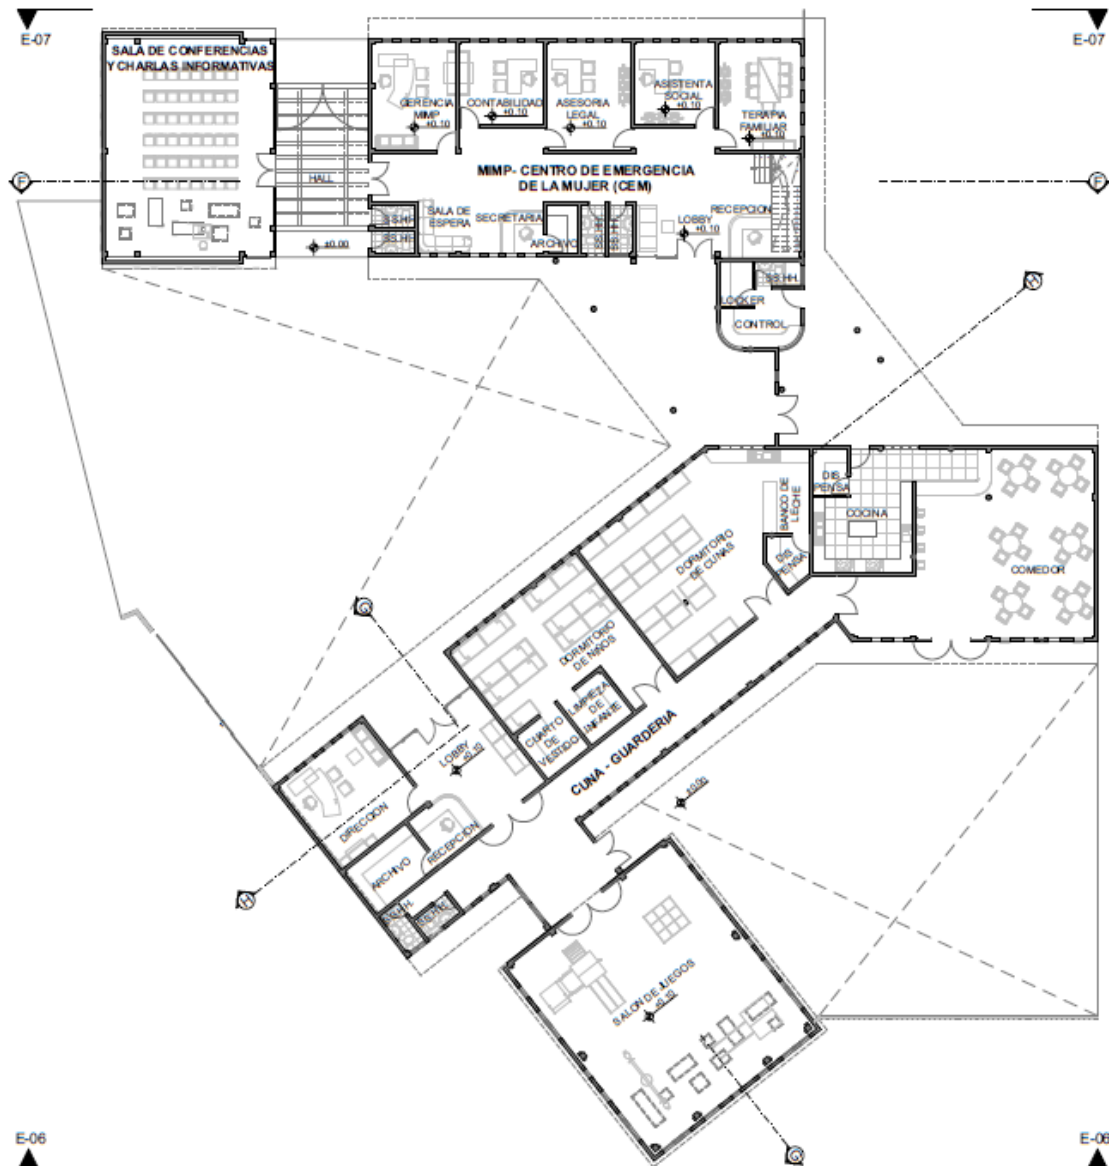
Distribución del primer nivel de la Cuna Guardería y CEM.
